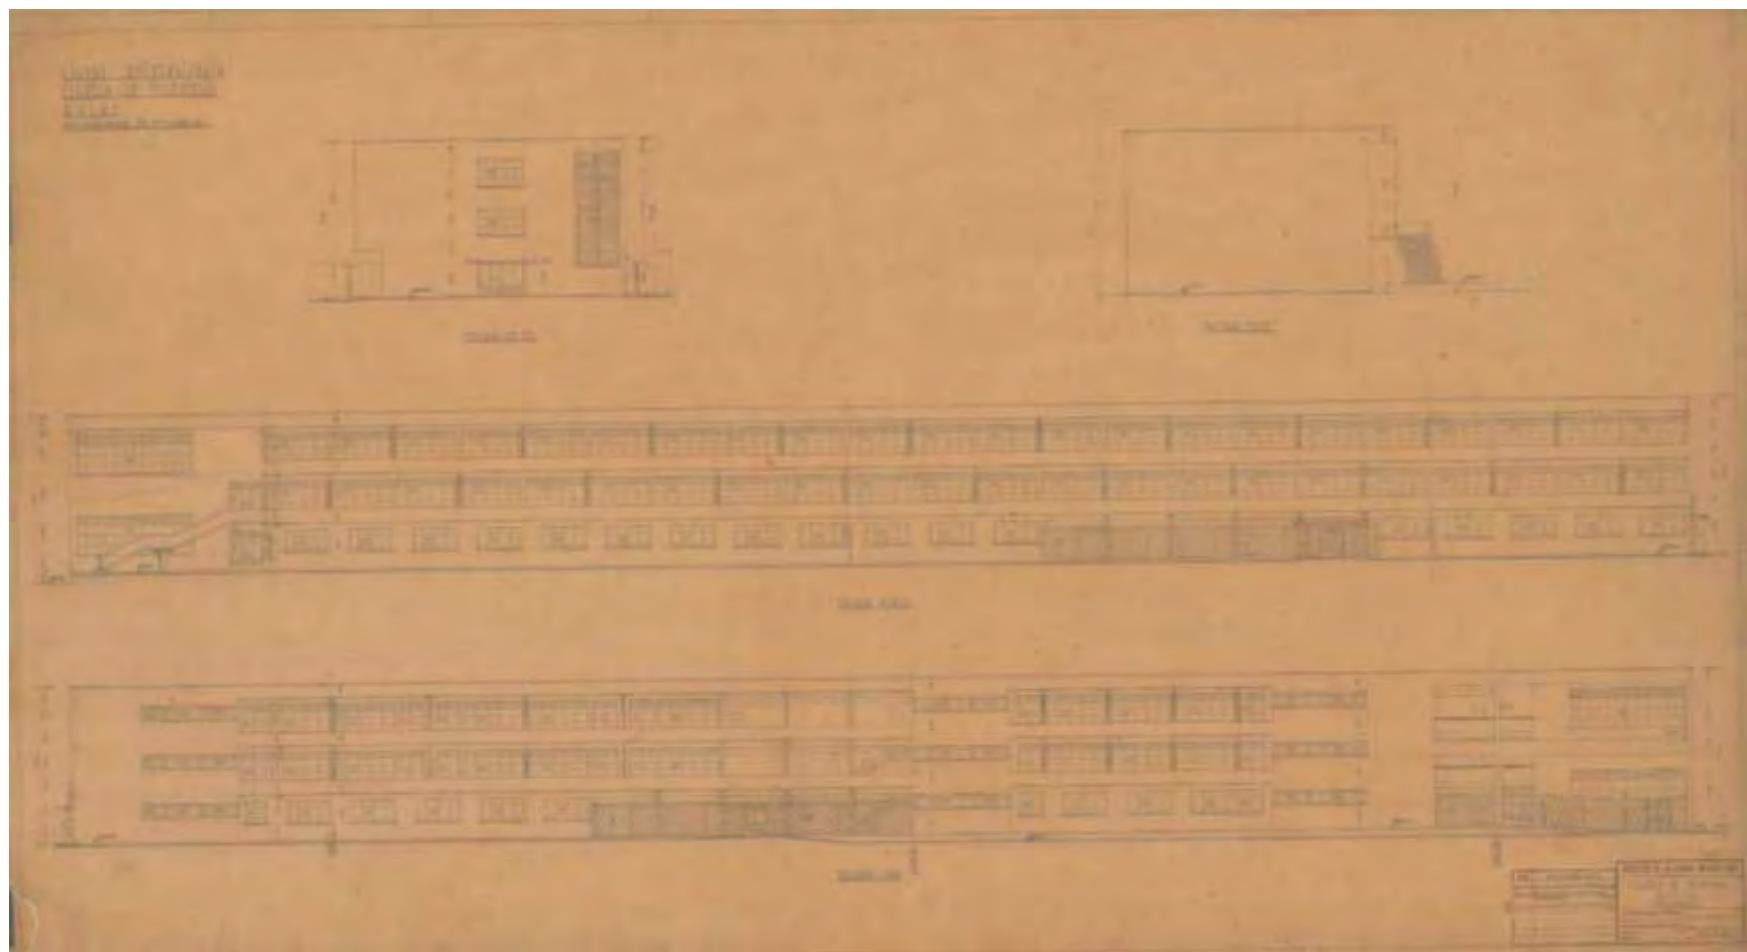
Plano 20-A-10. Fachadas Escuela de Ingeniería. Fuente: Colección CUC-ICU / COPRED-UCV.
